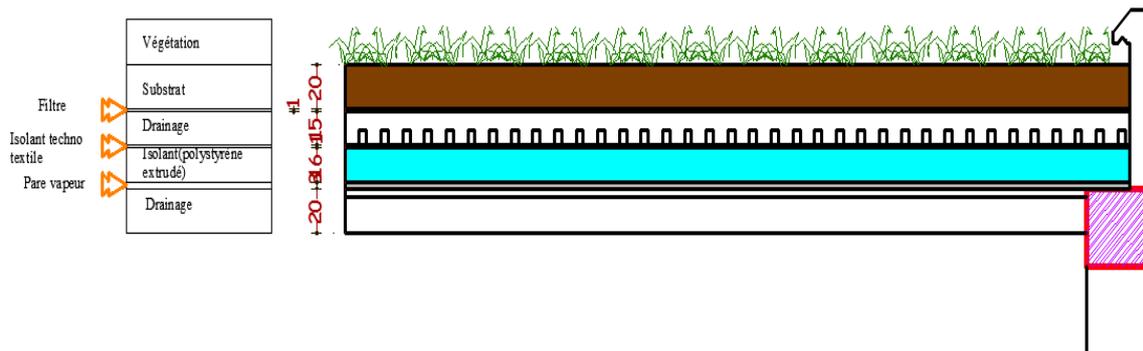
coupe sur la toiture végétalisée de type extensive (source auteur).
